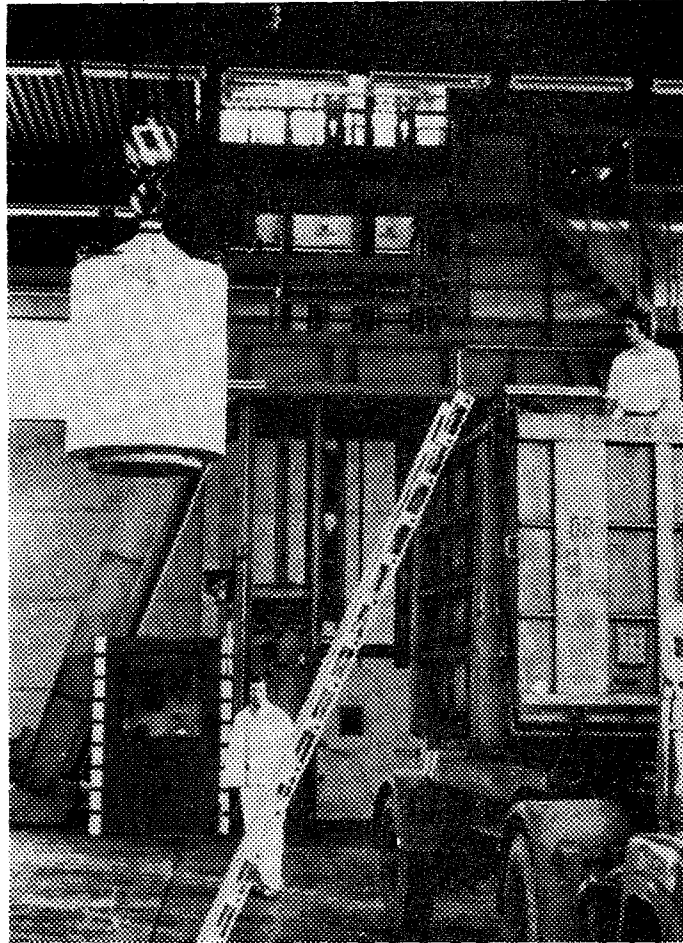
Transport der Betonabschirmungen in der Schachthalle
